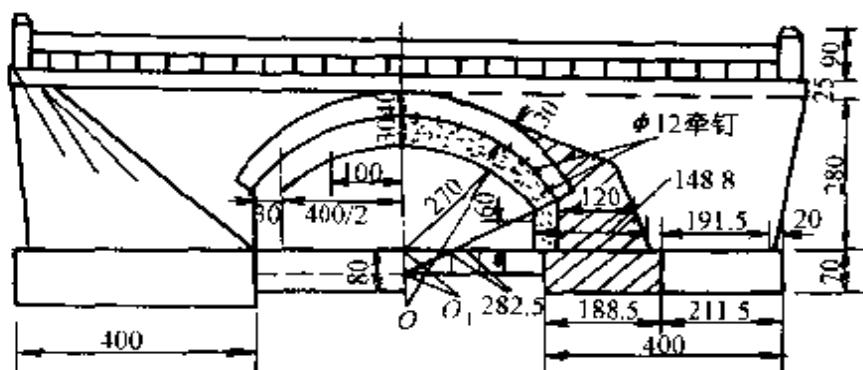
钢筋混凝土拱圈内壁浇筑加固法(尺寸单位:cm)
